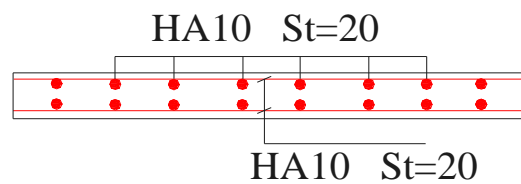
Schéma de ferrailage de la dalle d'ascenseur
